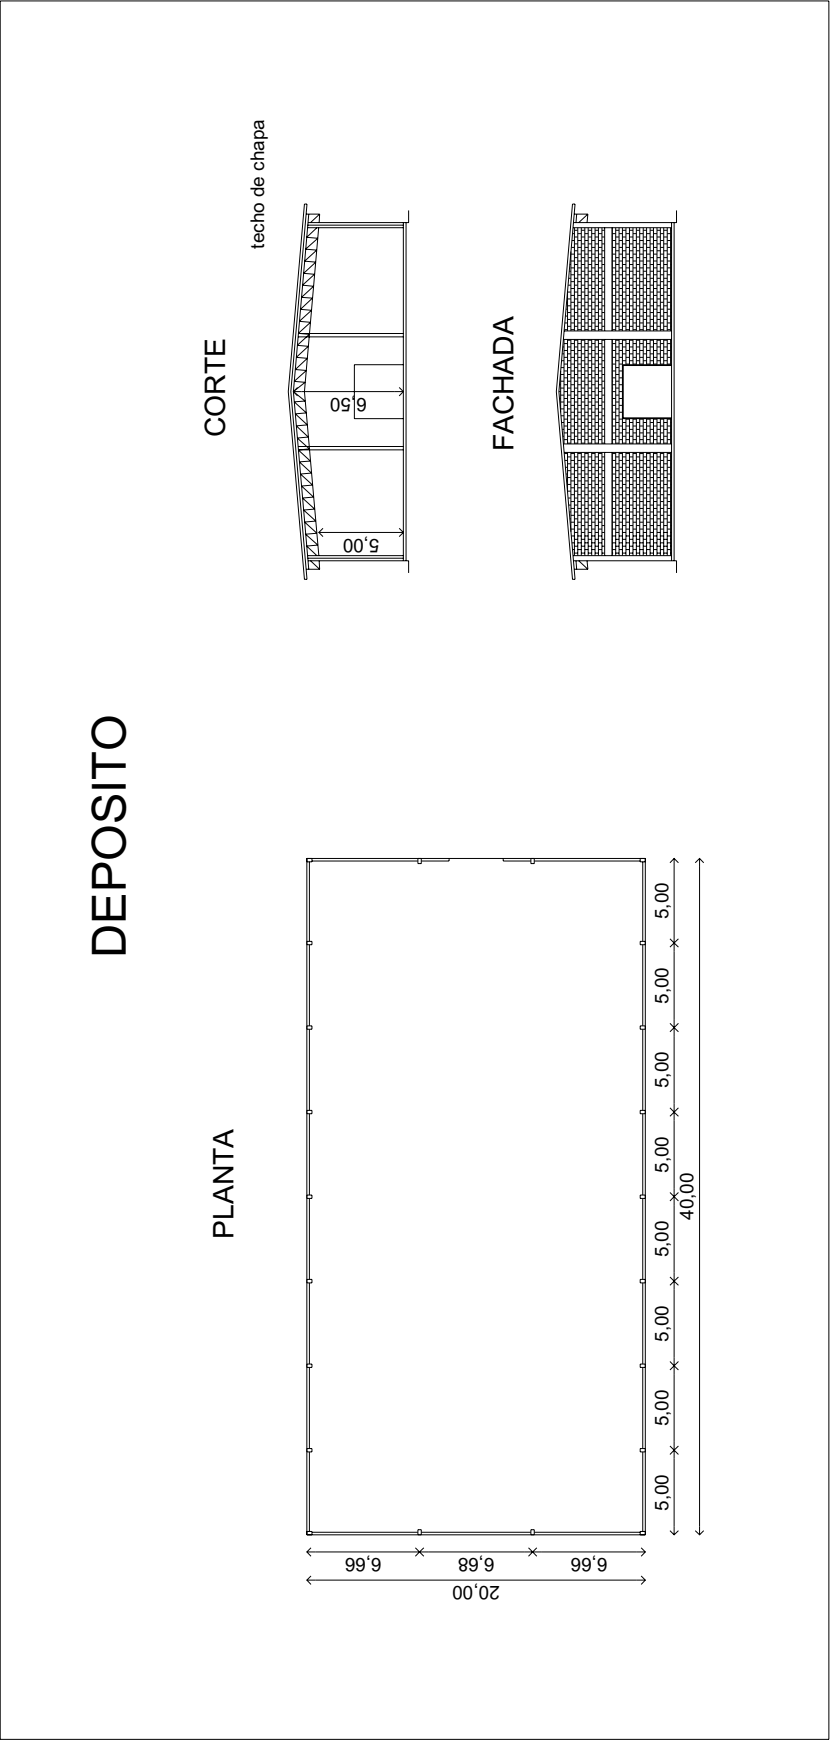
Plano del Piso y la Sección Transversal del Depósito
